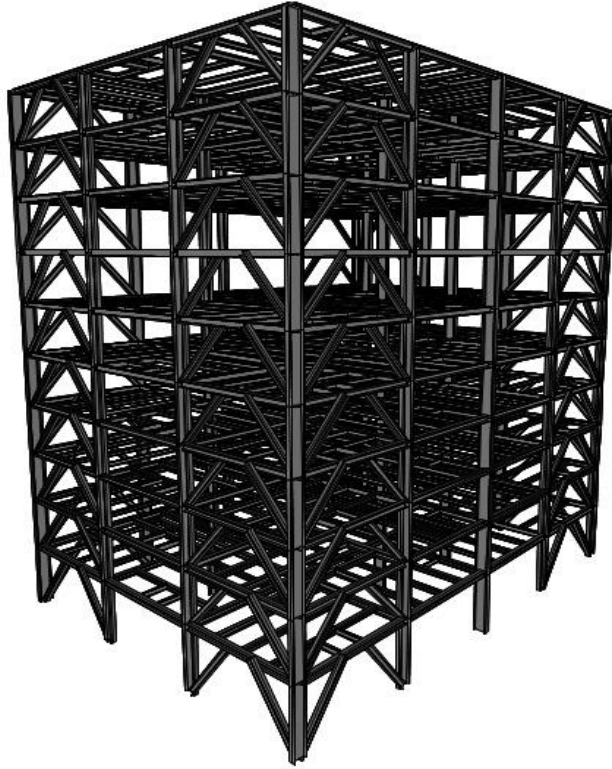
DÇÇ Sistemlerin Yapı Planı
